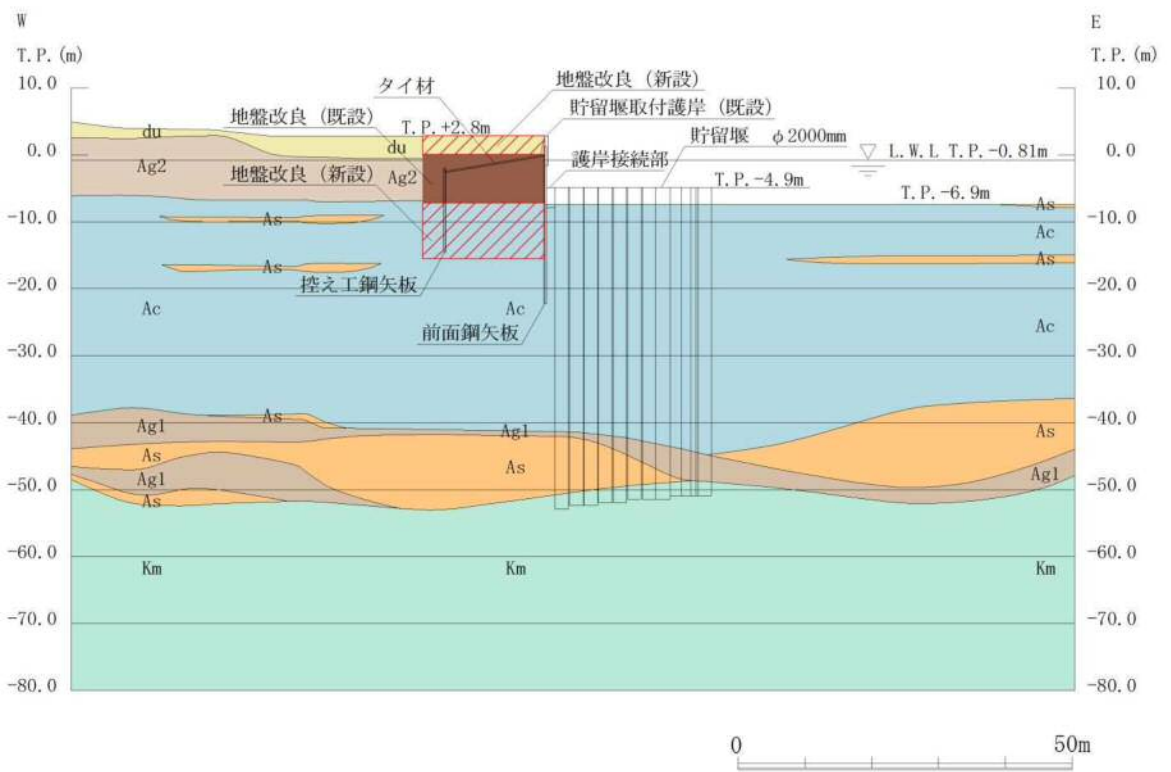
貯留堰取付護岸の断面図 (EW-1)
